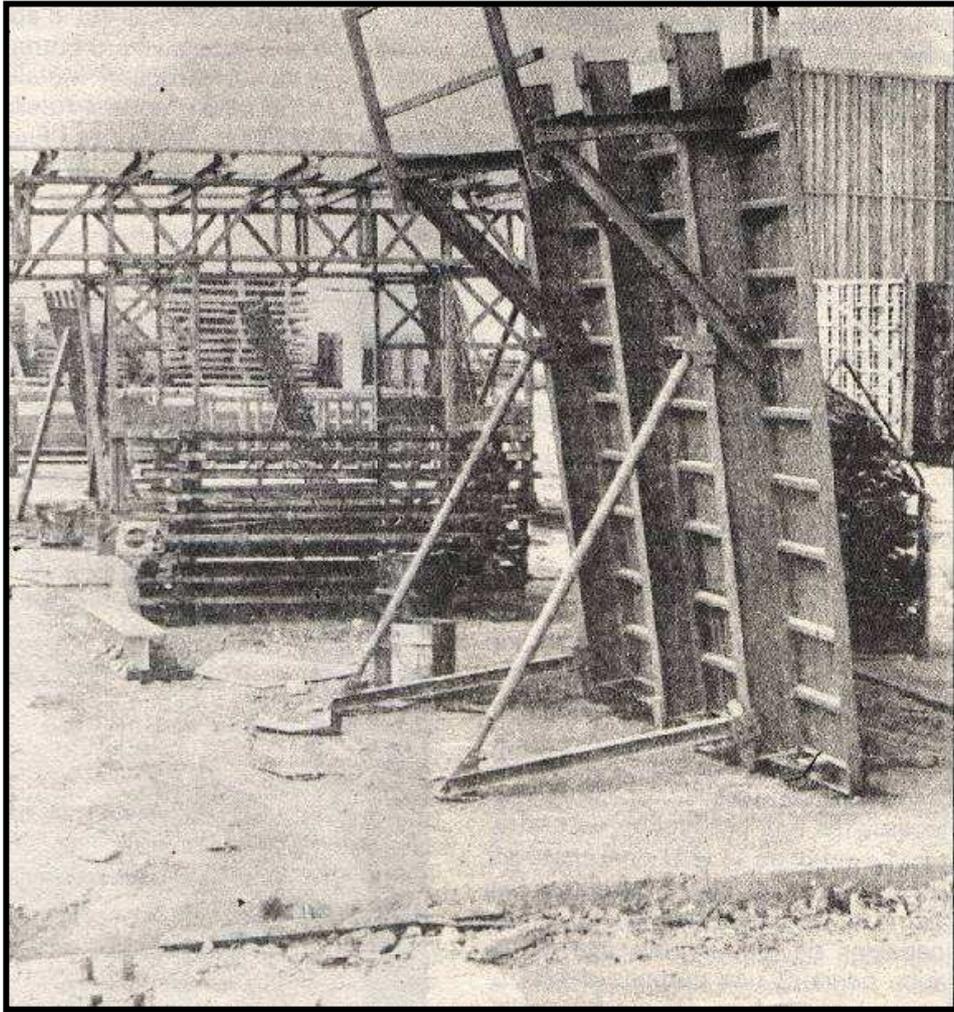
Le coffrage table et banche. Source : Revue Construire n° 03.
